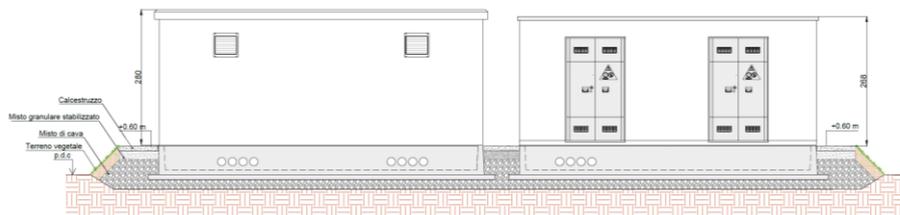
Planimetria e prospetto della Cabina di Trasformazione e Cabina inverter
